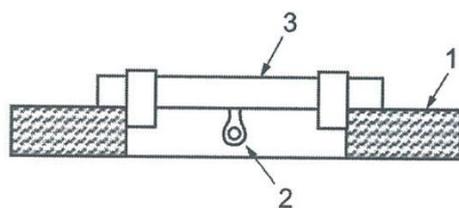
Tipo A1 - Exemplos de dispositivos de ancoragem presos por ancoragem estrutural ou por elementos de fixação. Fonte: NBR 16325-1
